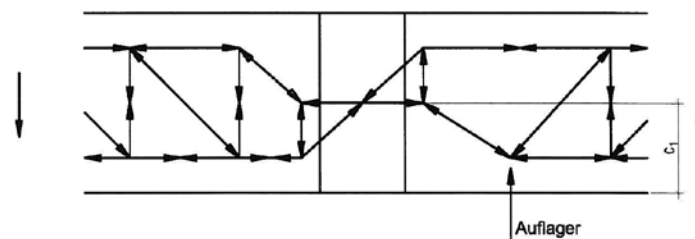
Schöck Isokorb Typ Q mit Betondrucklager
